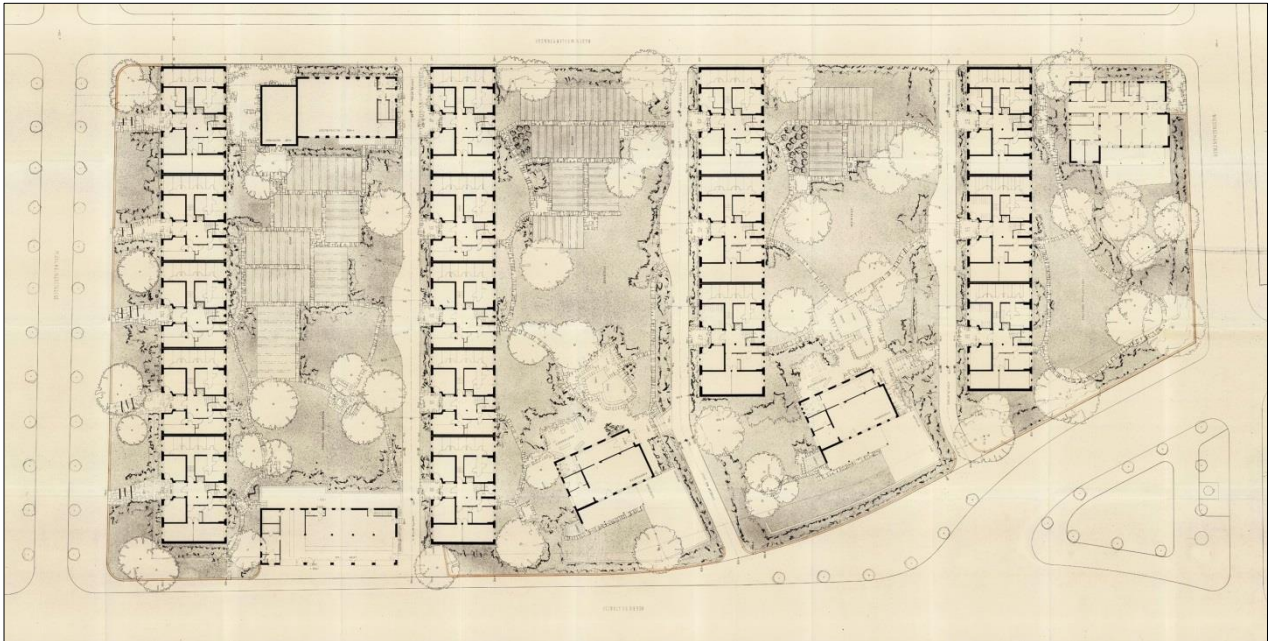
Situationsplan Projekt 1947; Quelle: Staatsarchiv Basel-Stadt (kein Massstab, Plan genordet)
